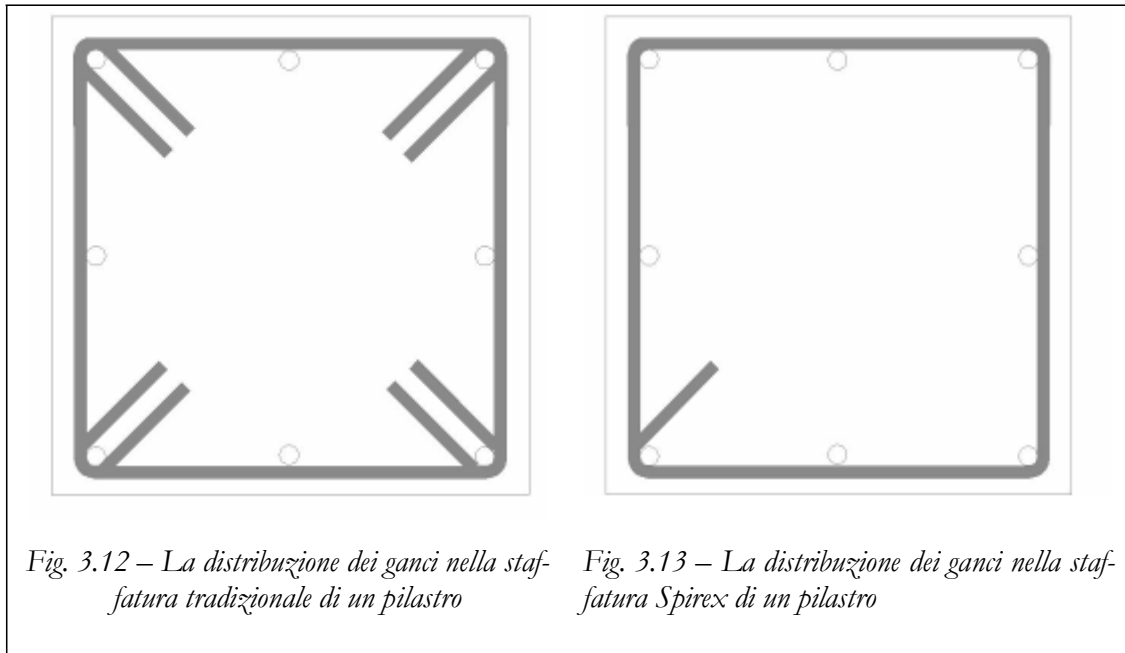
La distribuzione dei ganci nella staffatura tradizionale di un pilastro
